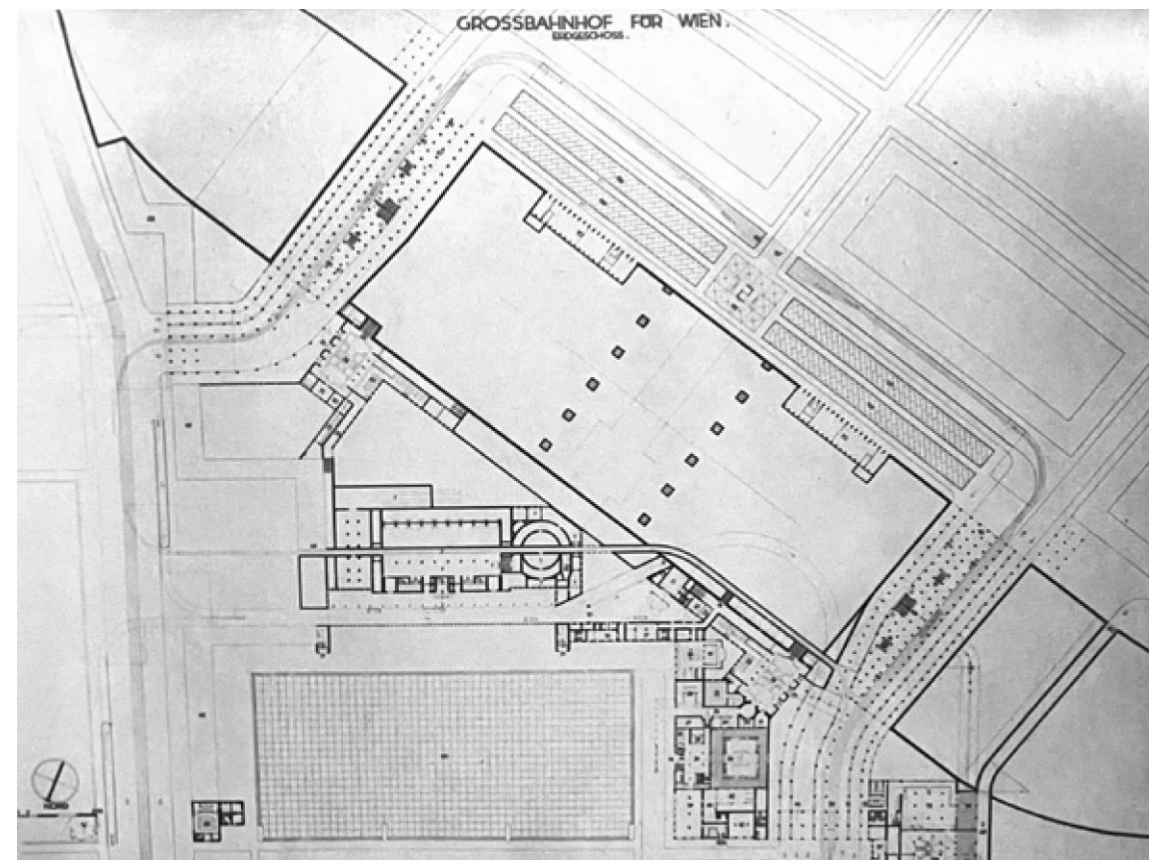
Dissertation Hans Aigner Entwurf Großbahnhof Wien, Erdgeschoss Grundriss 1937
